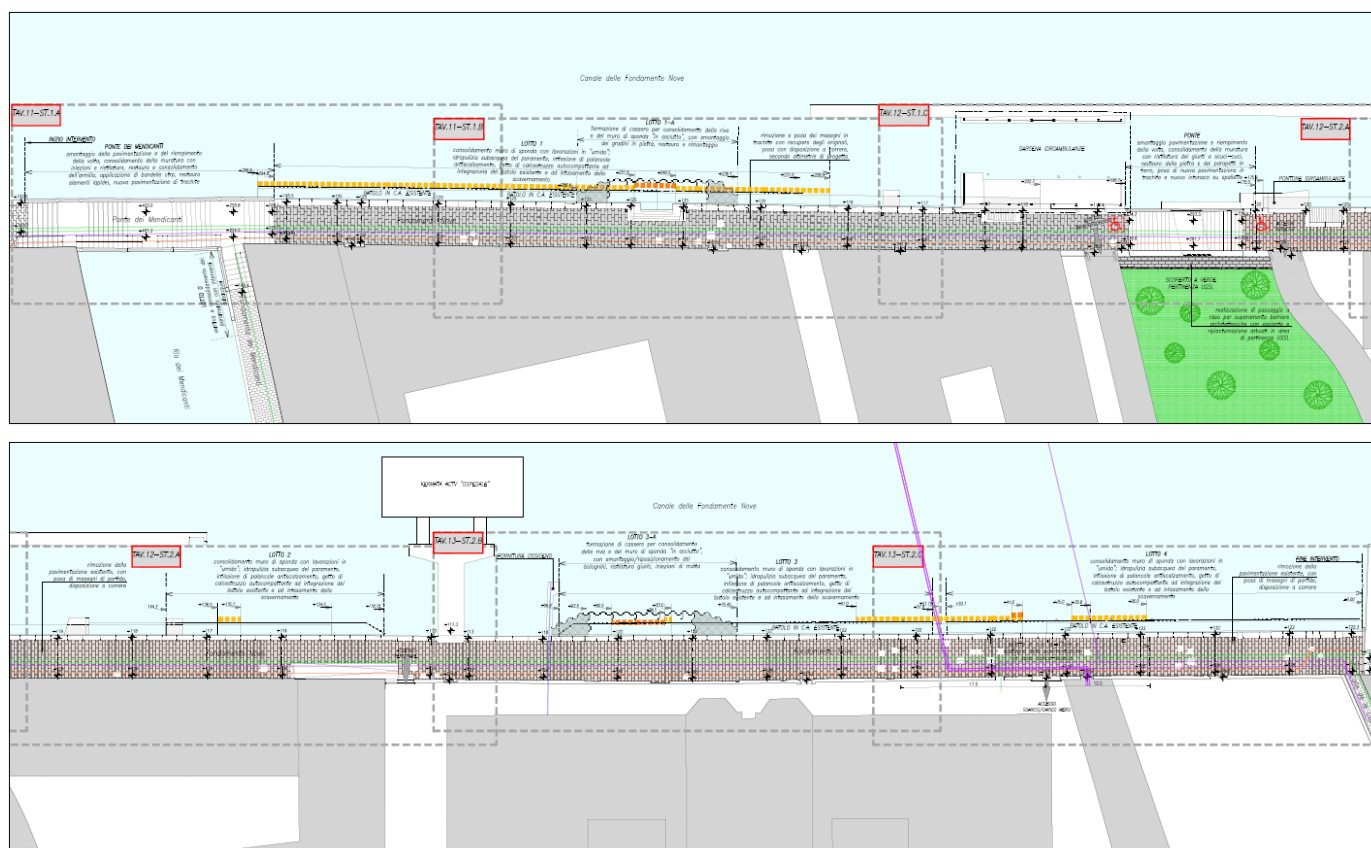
Planimetrie di progetto con individuazione lotti di lavorazione
